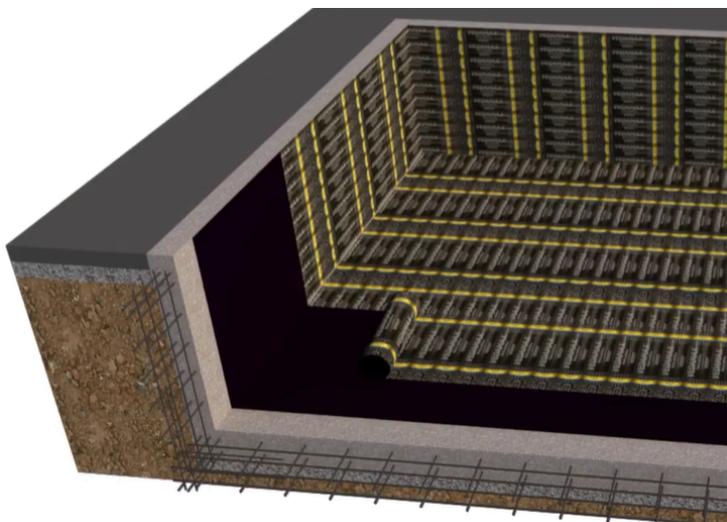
Corte esquemático de piscina de concreto até a fase de lastro
